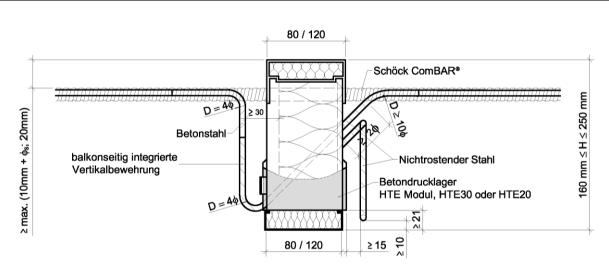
Schöck Isokorb® Typ K mit Sonderbügel
